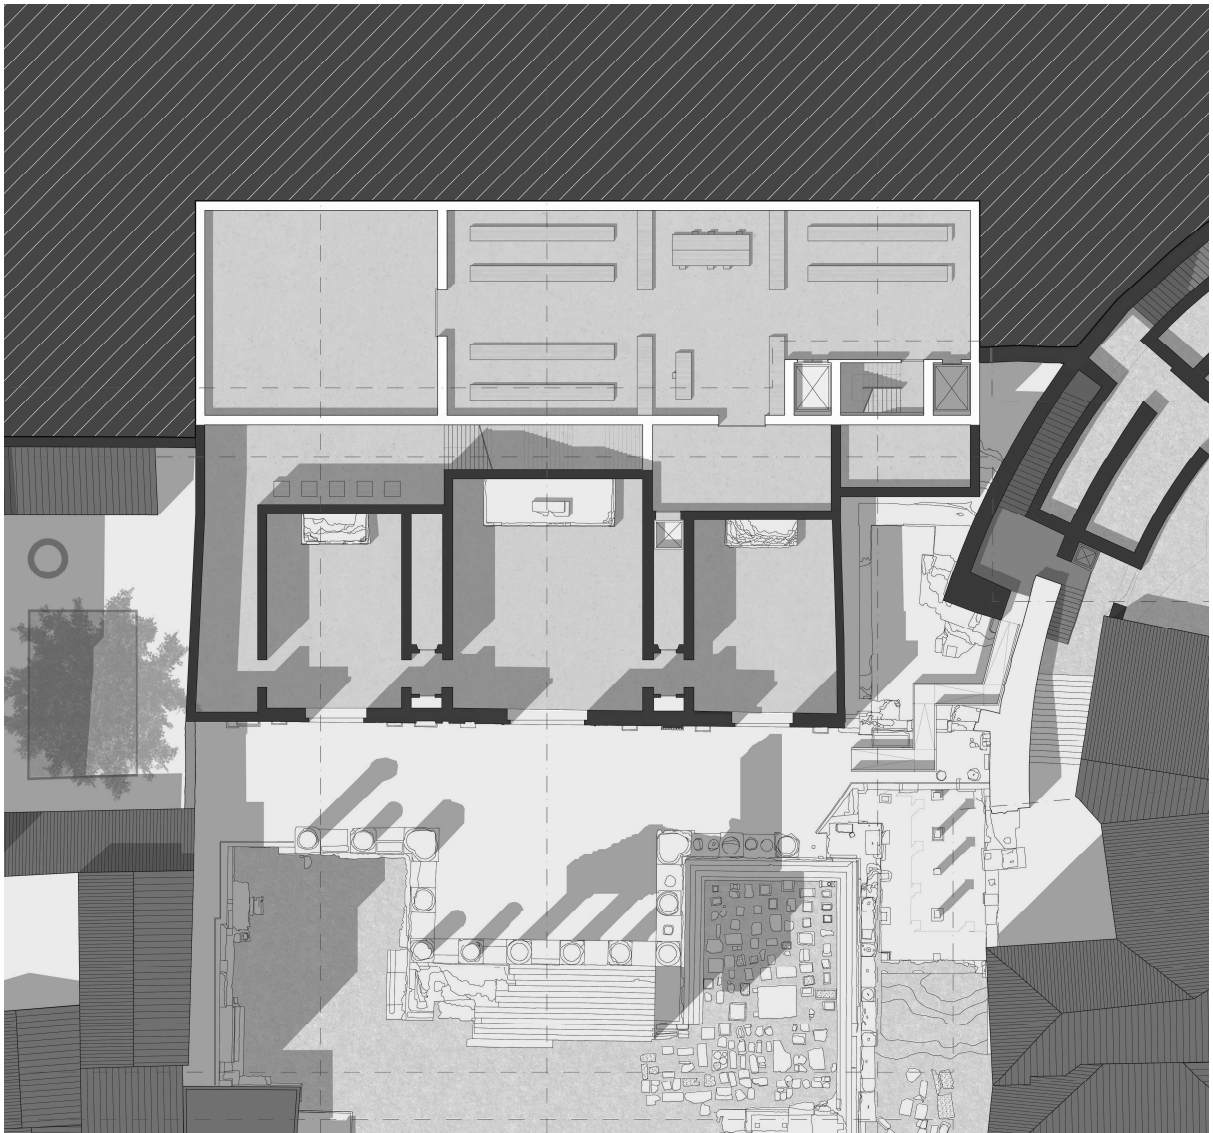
Pianta piano terra dell'edificio di progetto posto alle spalle del Capitulum
